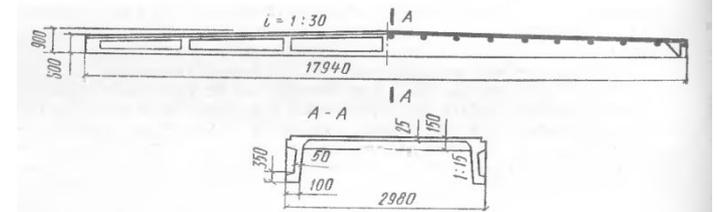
Схема ребристой плиты покрытия под малоуклонную кровлю размером 3×18 м
